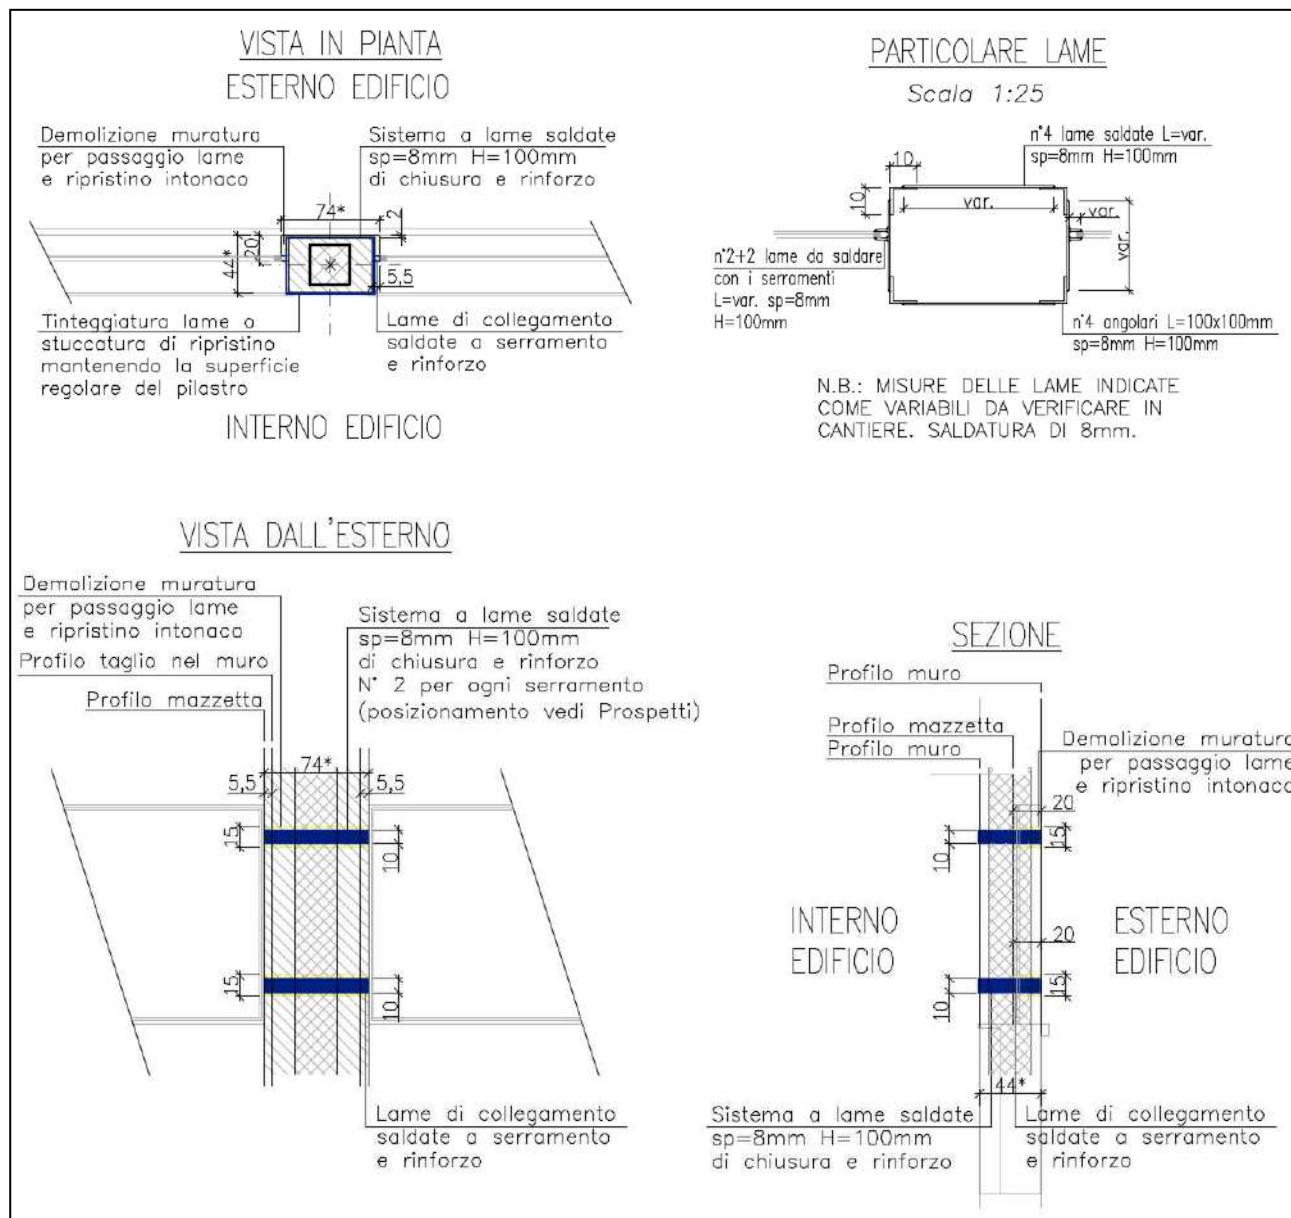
Estratto elaborati progettuali (prospetti e piante).
